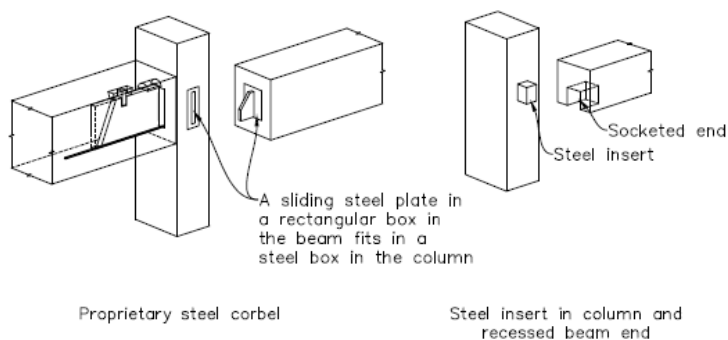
Ligação de pilar contínuo com apoios ocultos [3]
